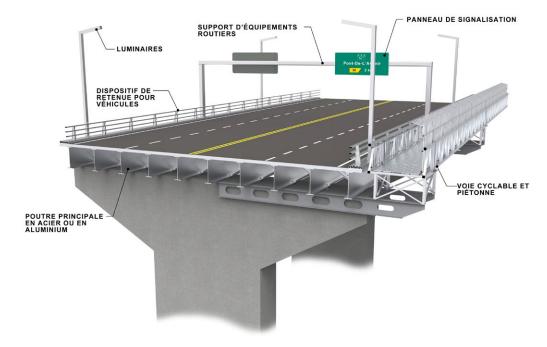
Utilisation de l'aluminium pour la fabrication d'éléments structuraux secondaires.
